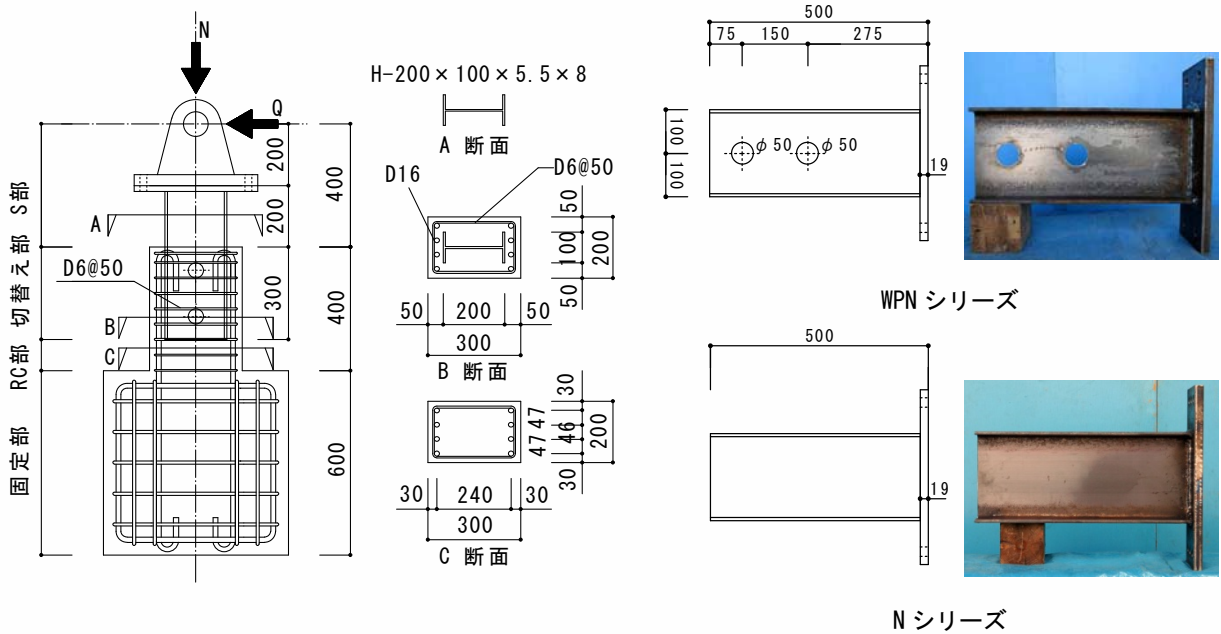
試験体の形状寸法, 断面, 鉄骨および配筋詳細
